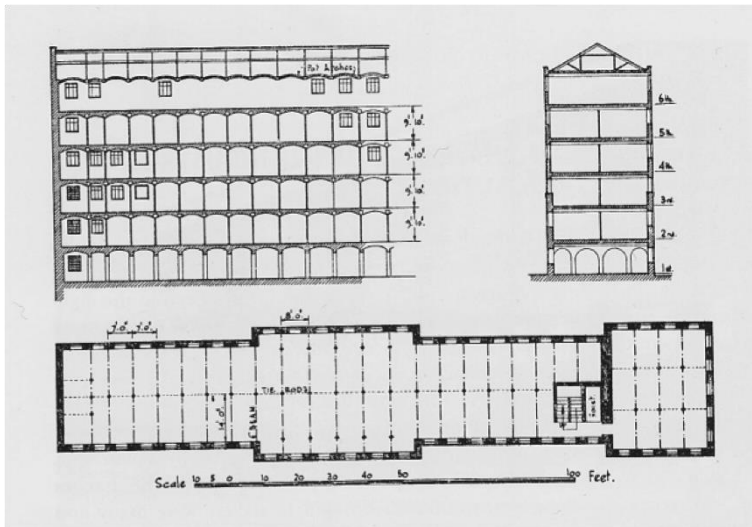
Planta e secções de West Mill, projetado por William Strutt em 1793.
